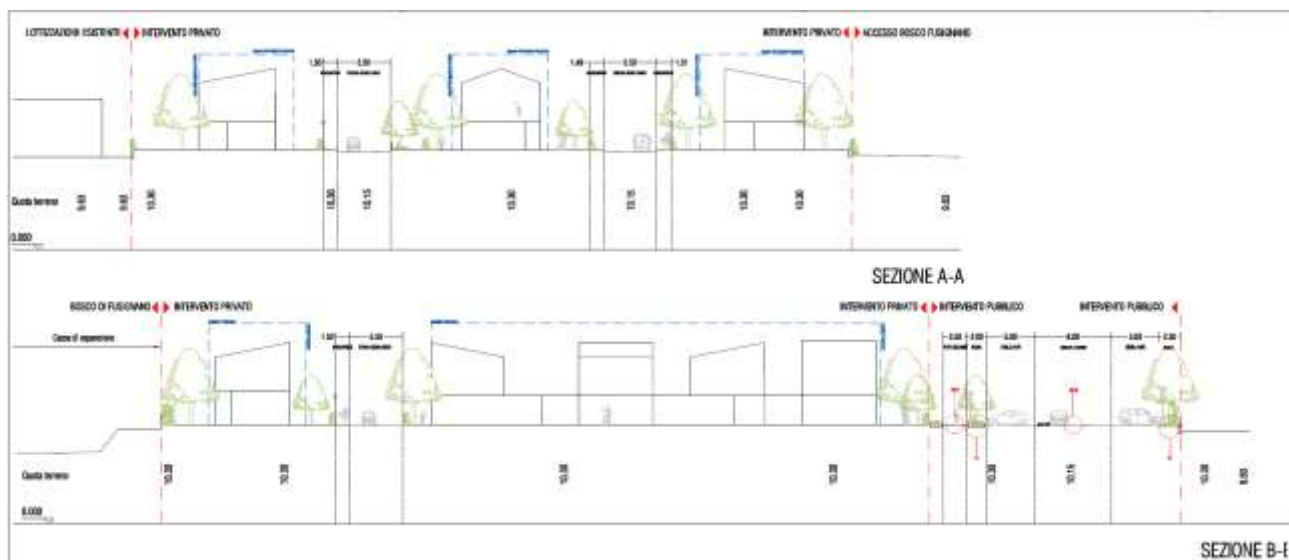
b – estratto di progetto tav. 4 – sezioni
